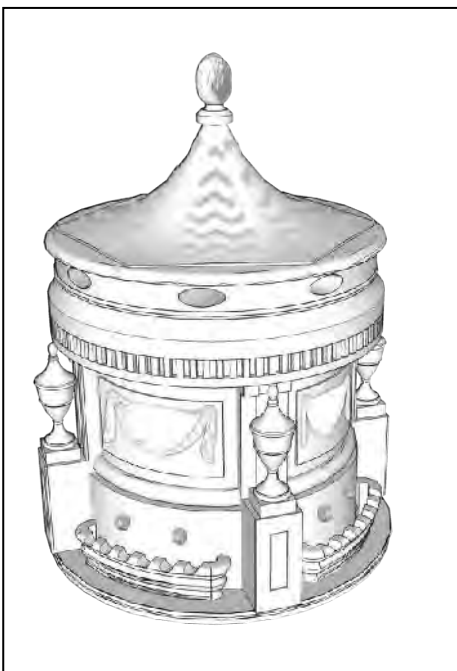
u.- Imagen intermedia, despiece de columna y pedestal con sus elementos.
